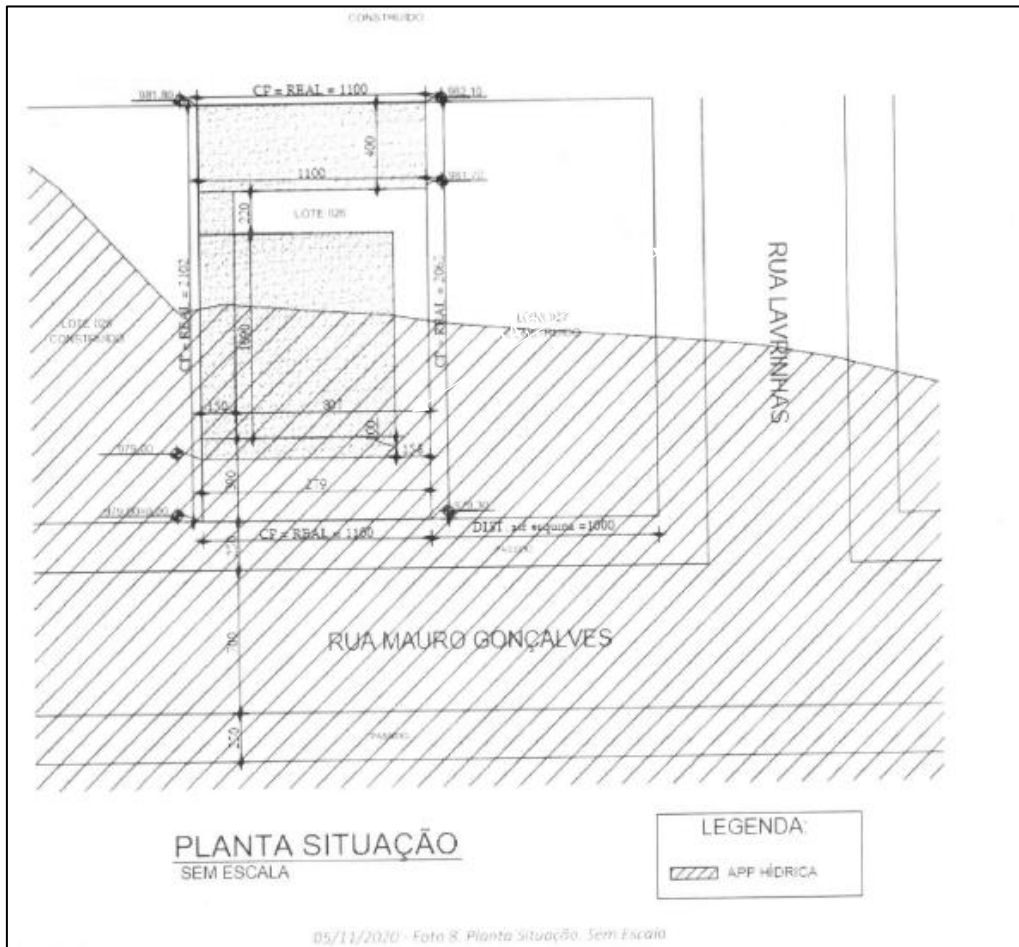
Planta de situação do imóvel sobreposto à APP. Fonte: Documento Protocolado em 07 de dezembro de 2020 (nº 8744/20).
